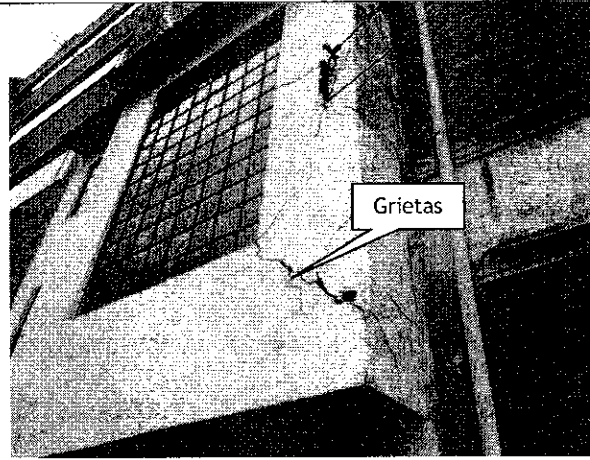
Vista de la fachada, a la altura del segundo nivel de la edificación, donde se observa la presencia de grietas que alcanzan un (1) centímetro de abertura.
